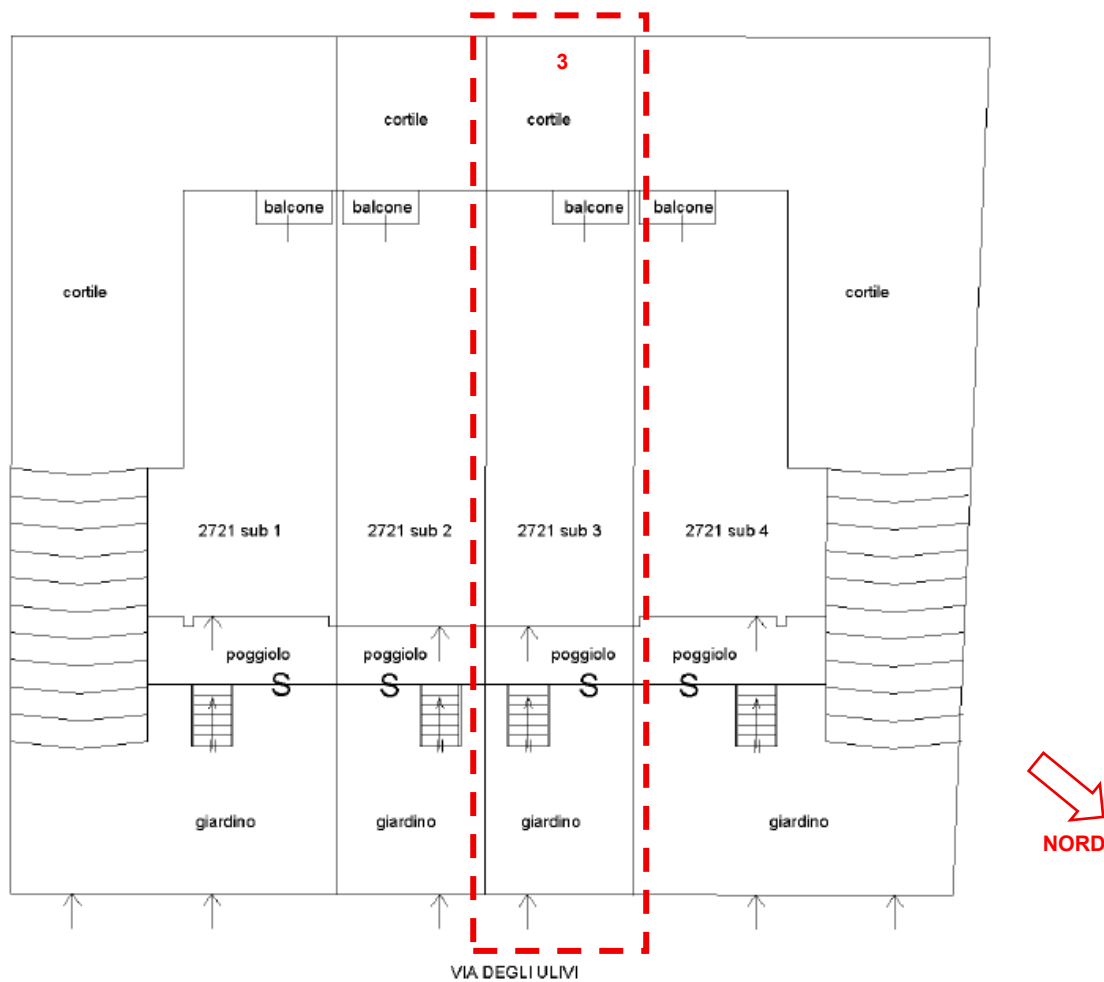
Stralcio dell'elaborato planimetrico (Piano T, fuori scala)
